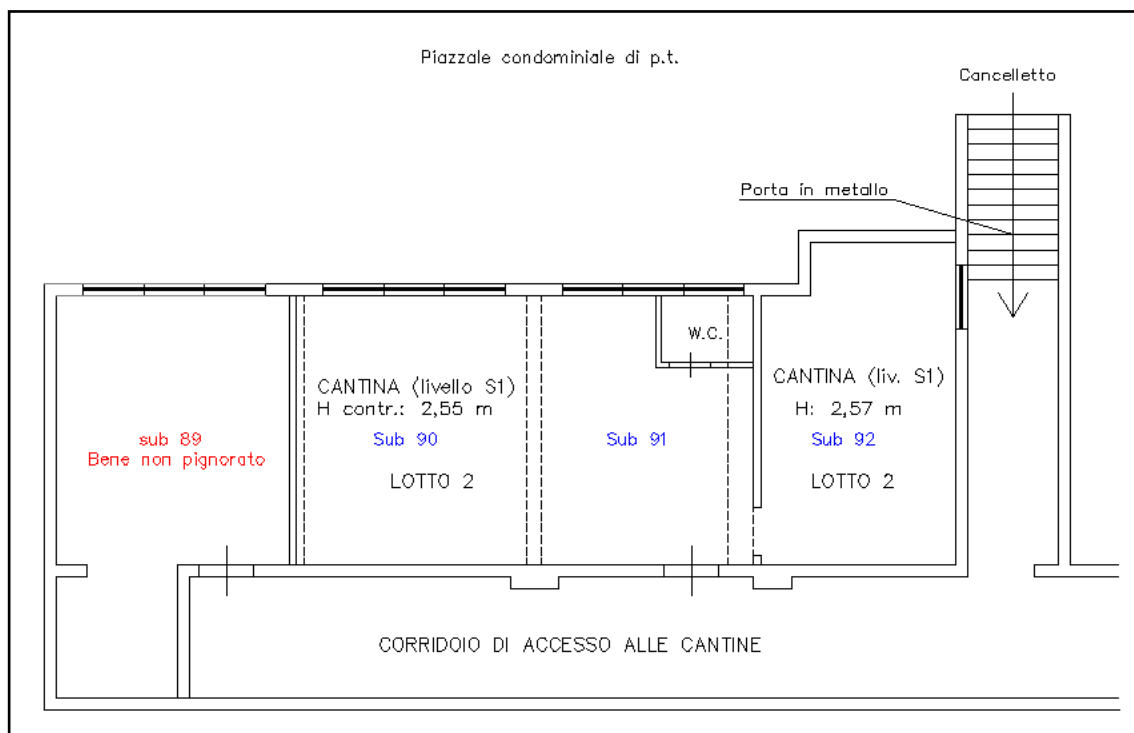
Estratto planimetrie catastali (All. 3.3)
